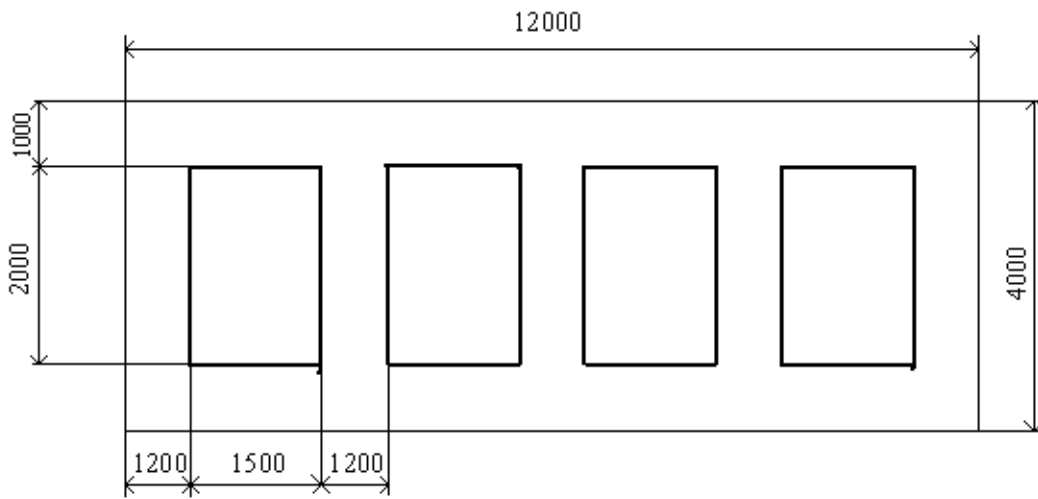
Поперечный разрез помещения к задаче 1.3.6
